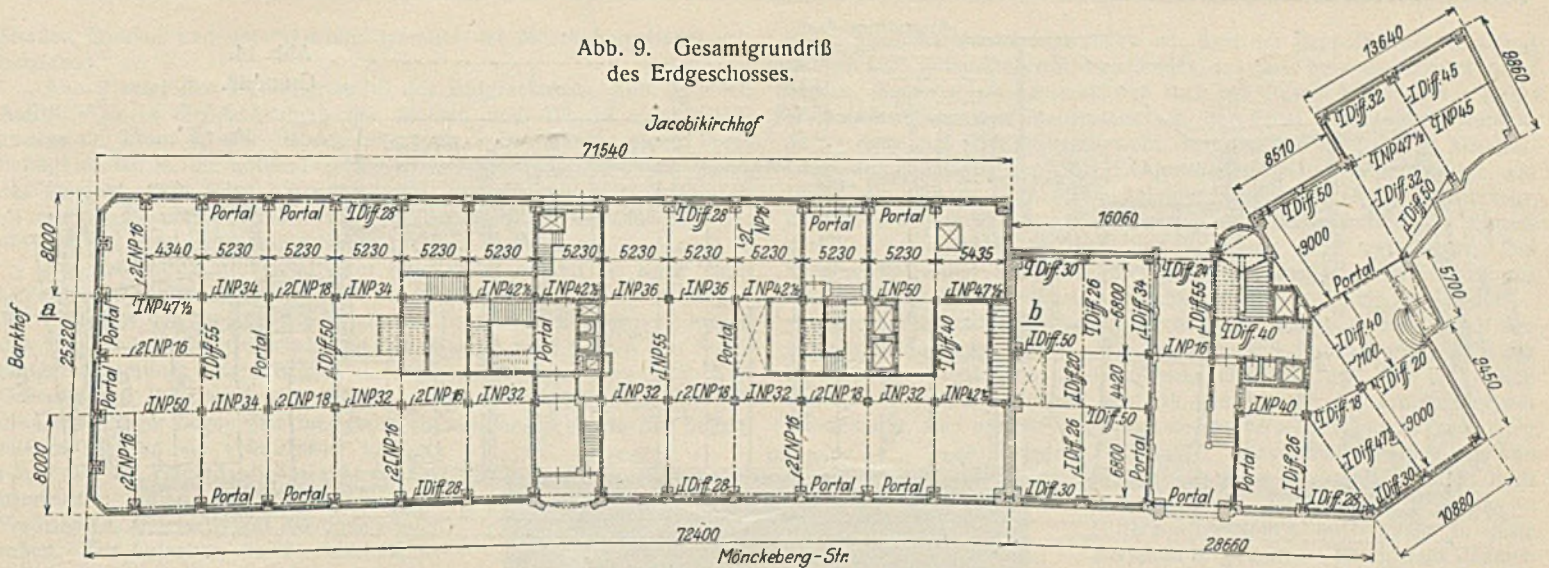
bis 12. Die Rappolthäuser. (Ausführung der Stahlkonstruktion: Dübler & Co., jetzt Carl Spaeter G. m. b. H., Hamburg.)
